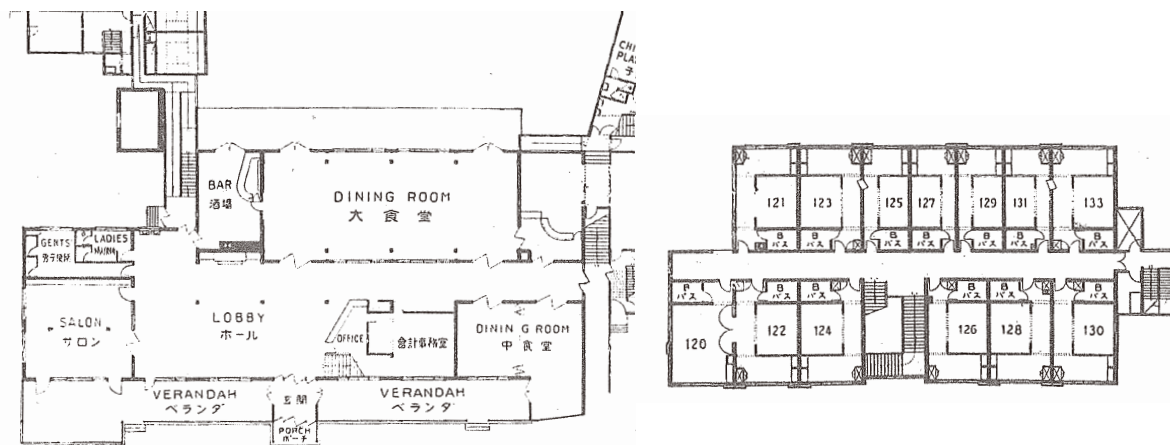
「軽井沢万平ホテル」(1936) 1階平面図(左), 2階平面図(右)
